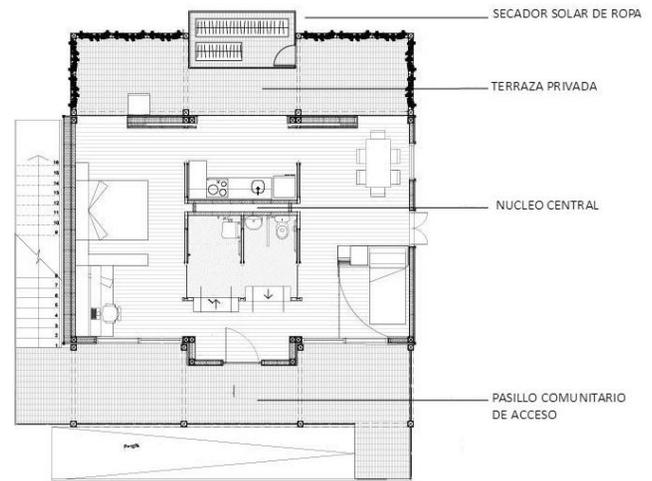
Módulo "Tendal" Planta departamento tipo. Elaboración propia Equipo Rubik.
